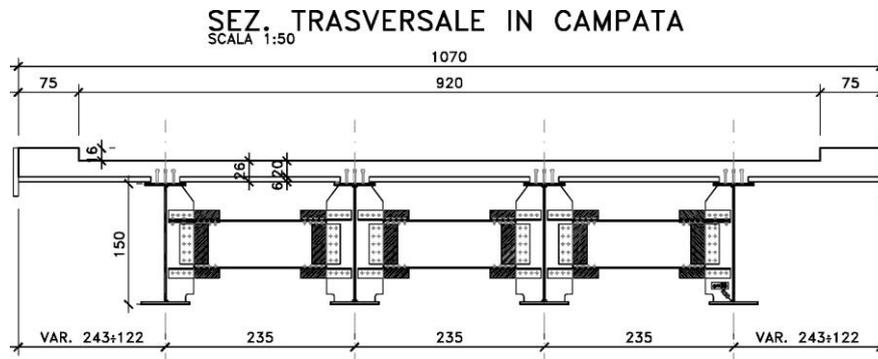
Sezione trasversale nuovo impalcato a 4 travi – Sezione corrente
